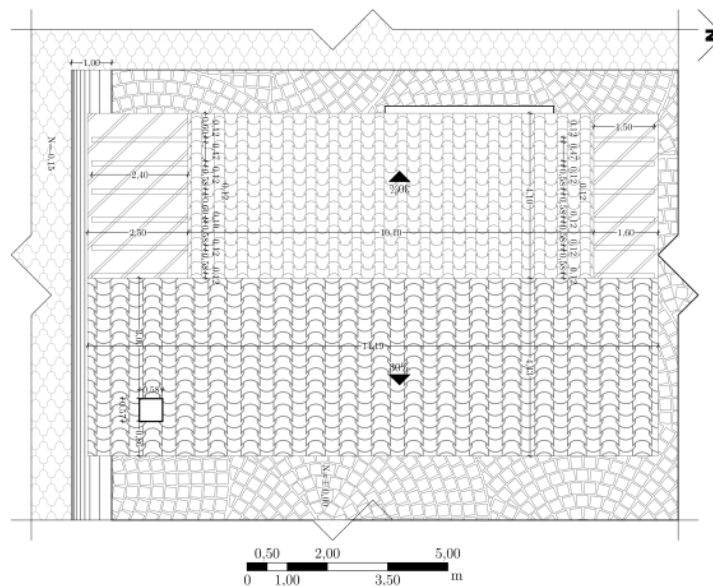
Planta de cubiertas, aplicando las recomendaciones de Guzmán (2016).
